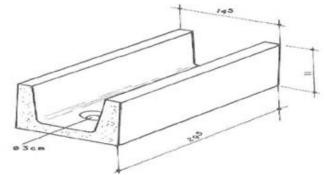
Detalhe do bloco perfurado para dar passagem ao eletroduto.
